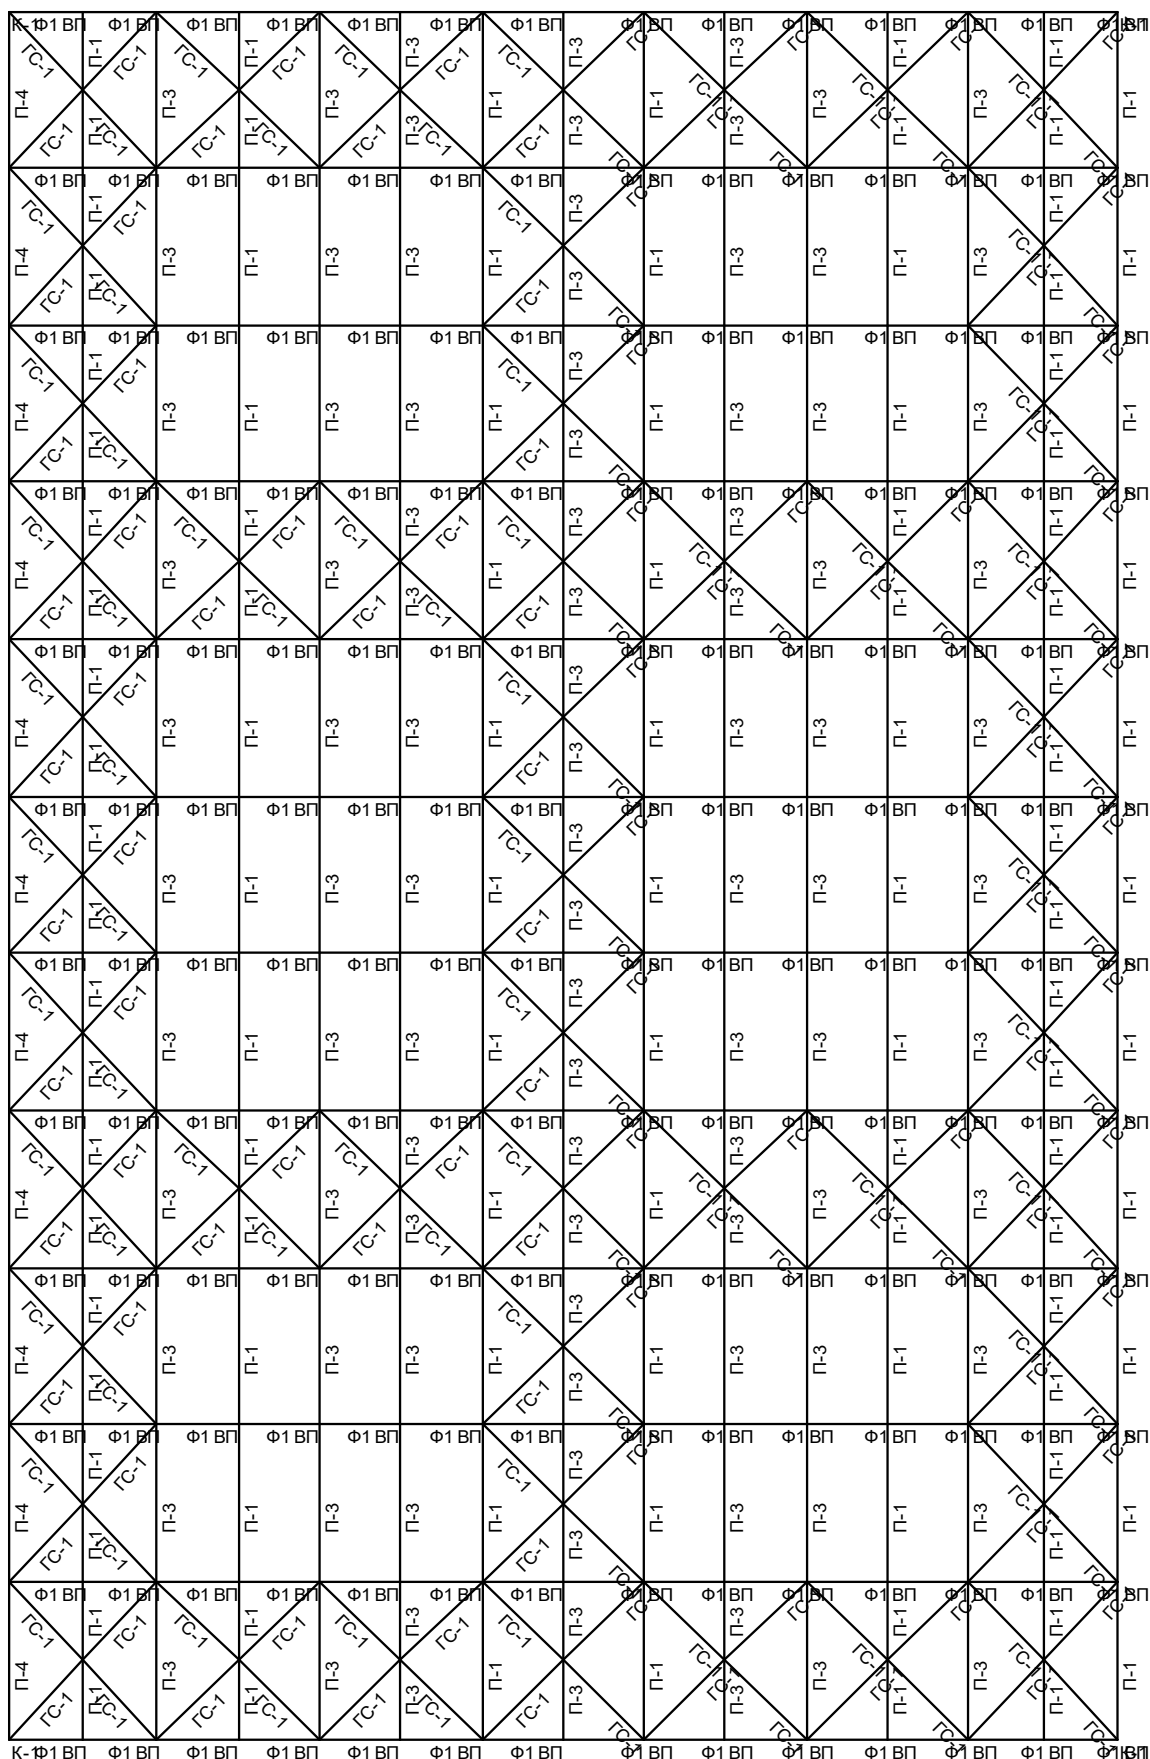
Схема прогонов и горизонтальных связей по верхнему поясу арочной фермы
